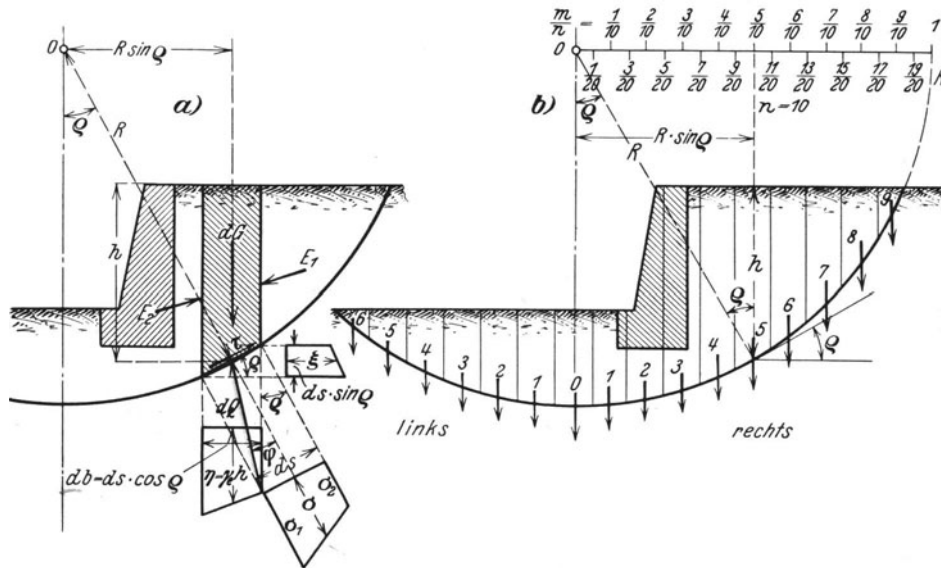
Untersuchung der Sicherheit gegen Grundbruch bei einer Stützmauer unter Zugrundelegung von gekrümmten Gleitflächen. (Nach H. Krey: Erddruck, Erdwiderstand.)
